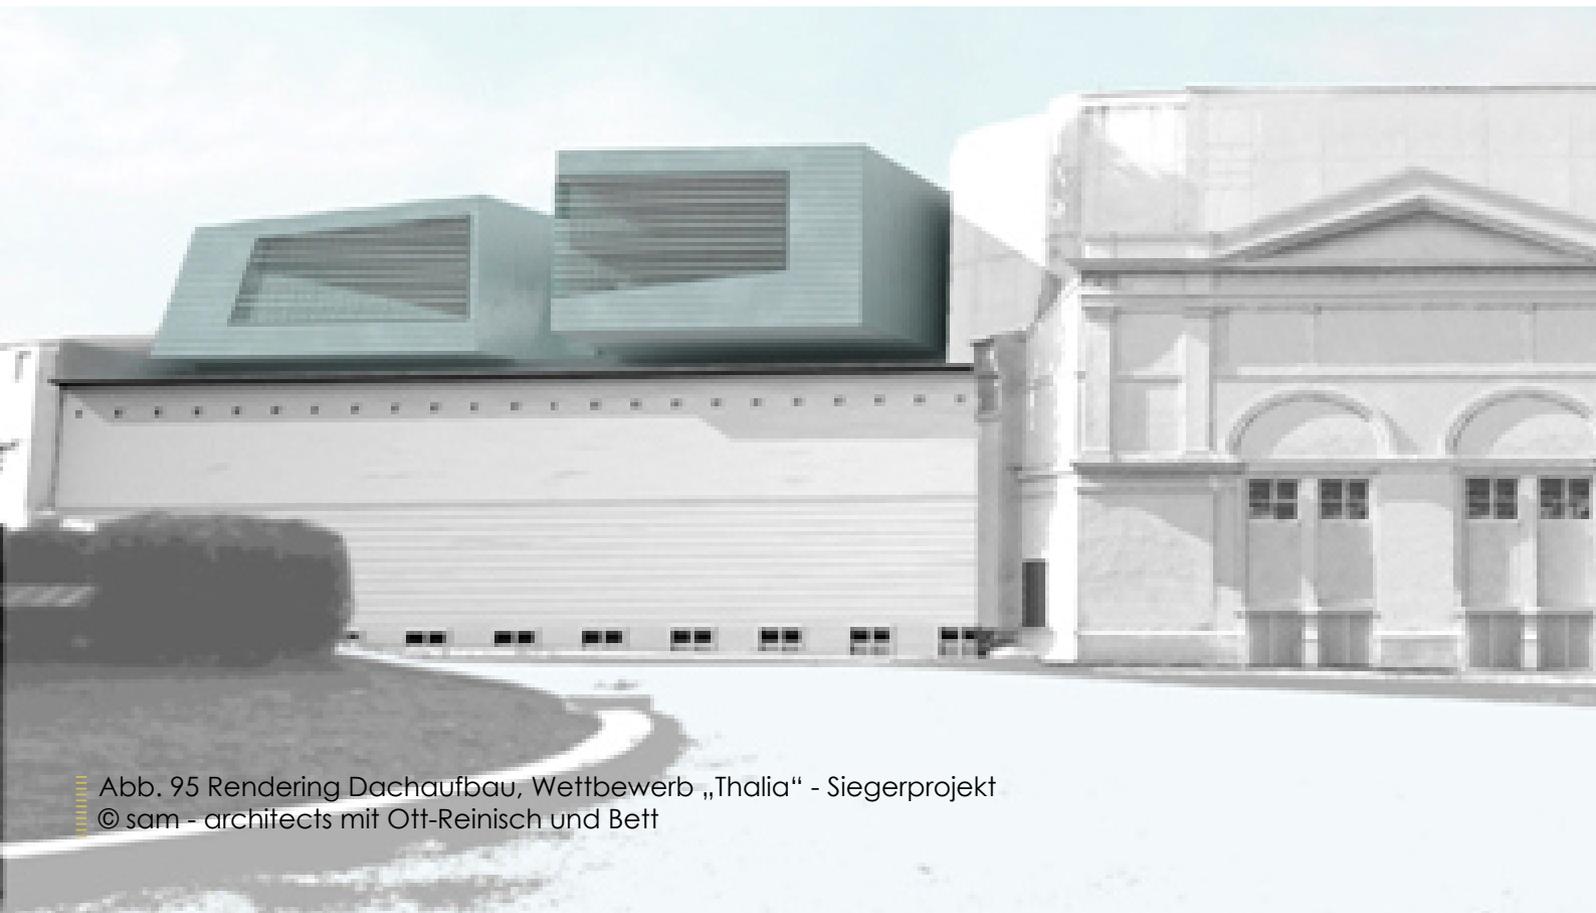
Rendering Dachaufbau, Wettbewerb „Thalia“ - Siegerprojekt
